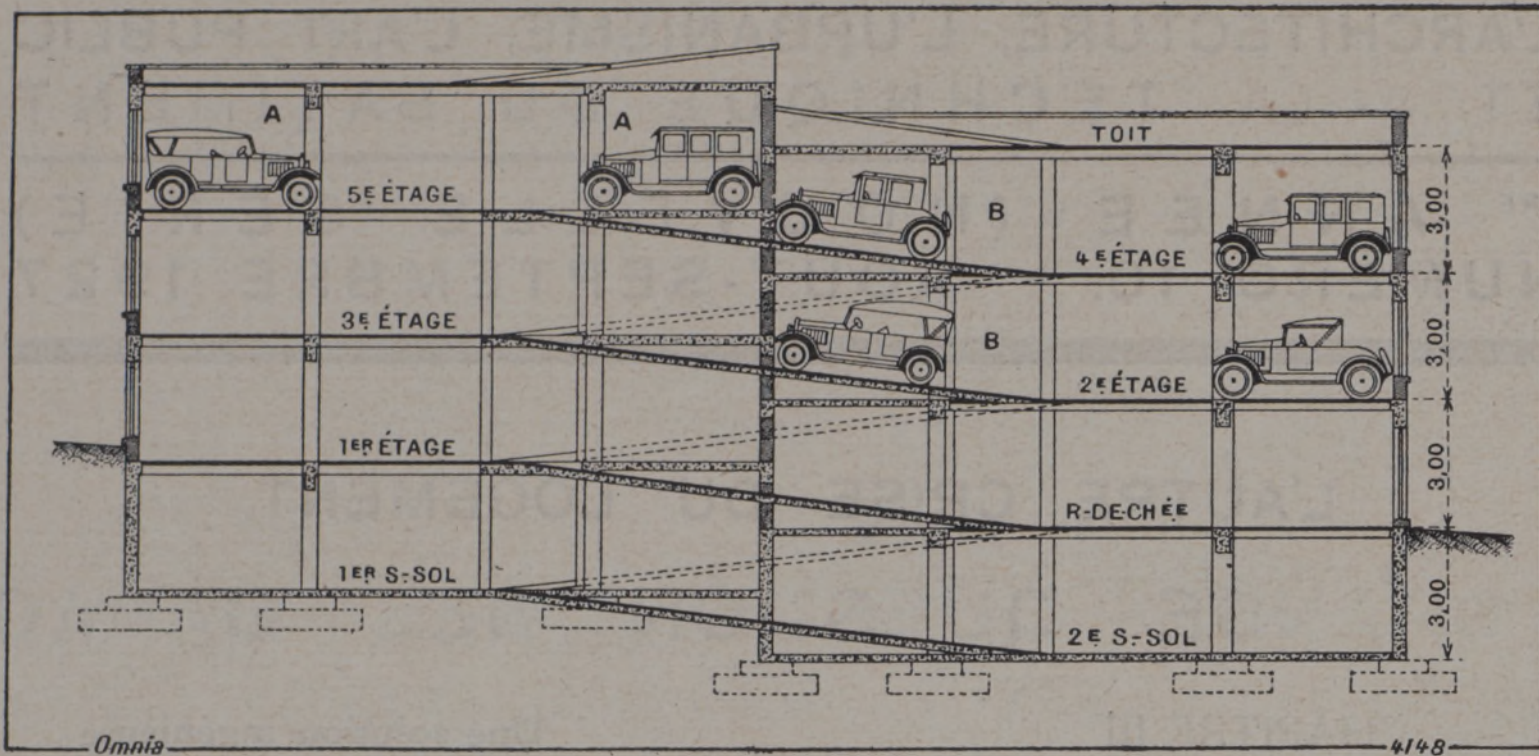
Fig. I. — Garage du système Humy Motorramp à étages décalés (coupe transversale par le milieu rampes (10 mètres environ) dont la pente est de 15 p.c. généralement. Sur ce dessin, les rampes du garage). — Les voitures montent ou descendent d'un étage à l'autre au moyen de courtes rampes qui vont du rez-de-chaussée au 1^{er} sous-sol, du 1^{er} au 2^e, du 3^e au 4^e sont figurés en pointillés.
